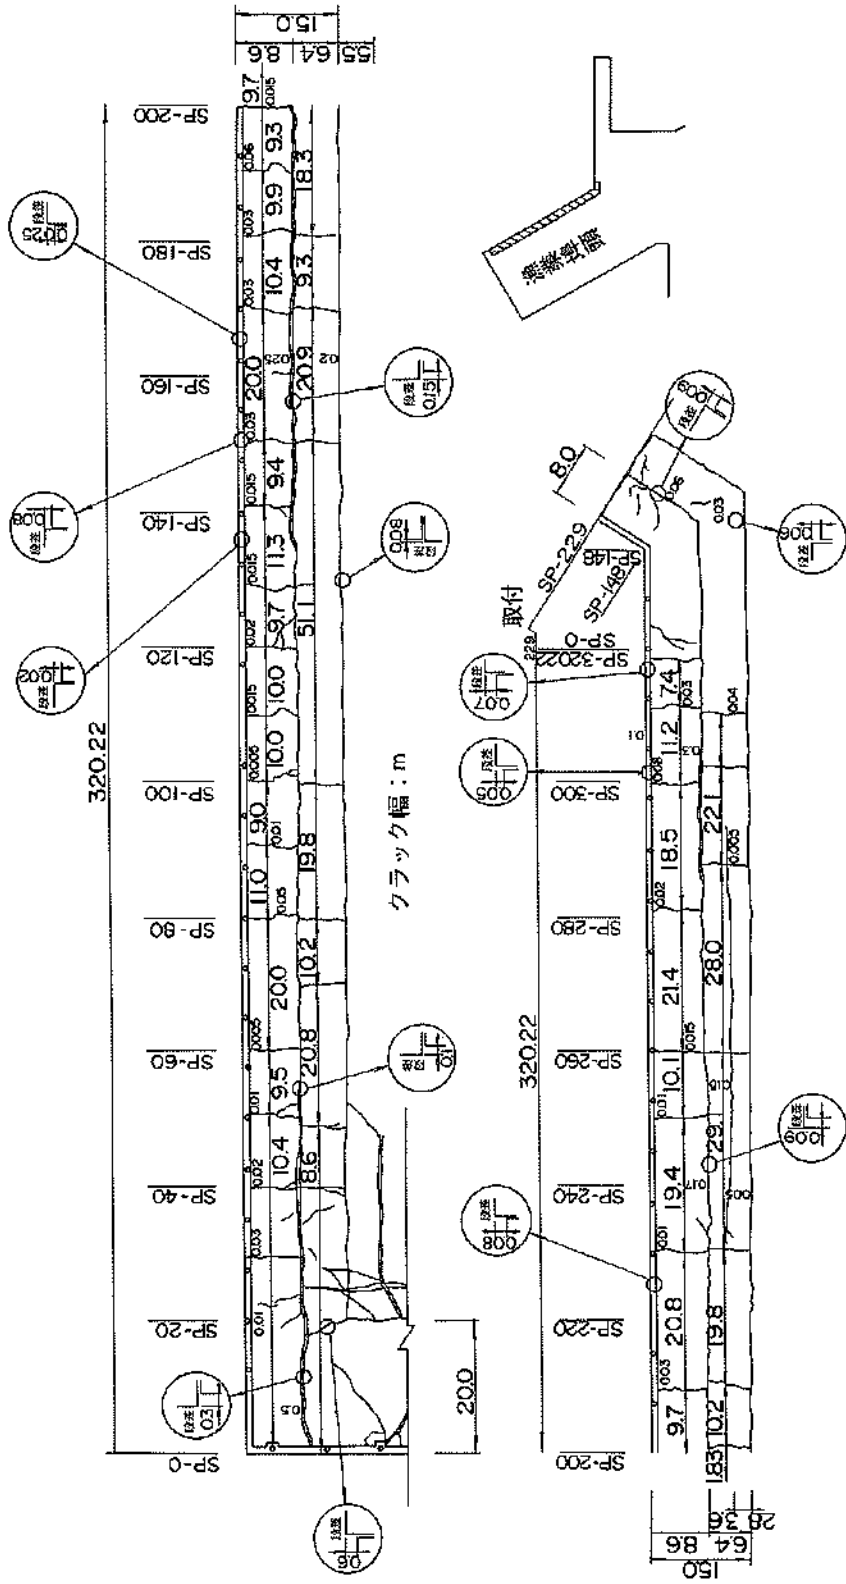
エプロンクランク平面図 (漁港埠頭, ③西側岸壁 (-7.0m))
